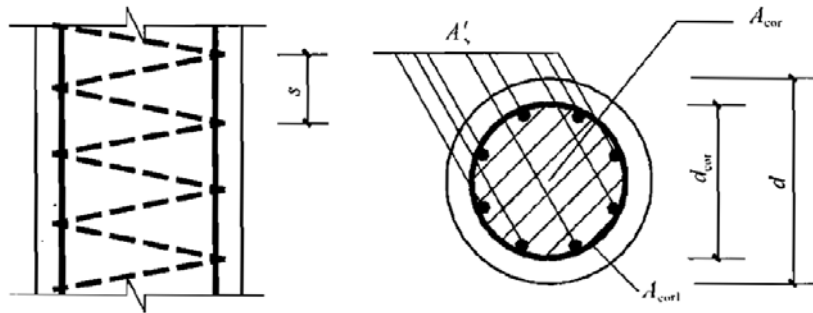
配置螺旋式间接钢筋的钢筋混凝土轴心受压构件
